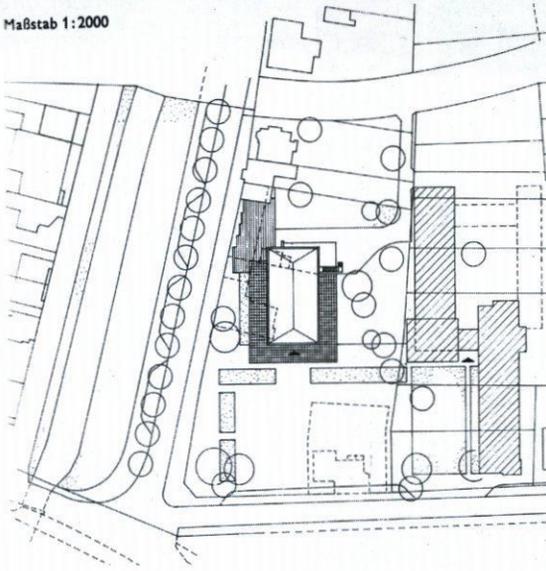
Lageplan mit Stadthalle und Kreishaus
